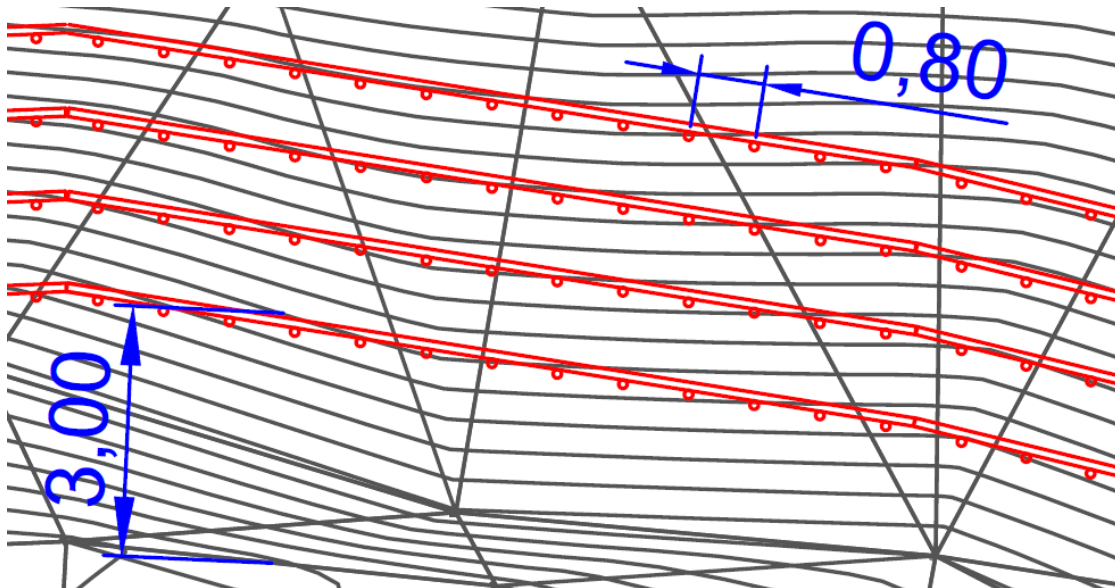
Vista en planta N°3 ubicación de trinchos. Fuente: Propia
